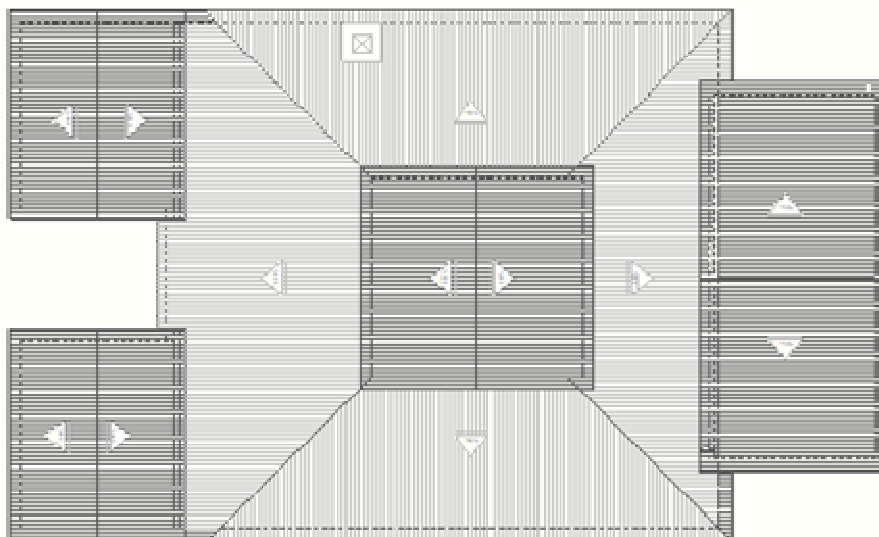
Planta de cobertura esquemática. Fonte: 19ª SR/IPHAN-PI, 2007.
